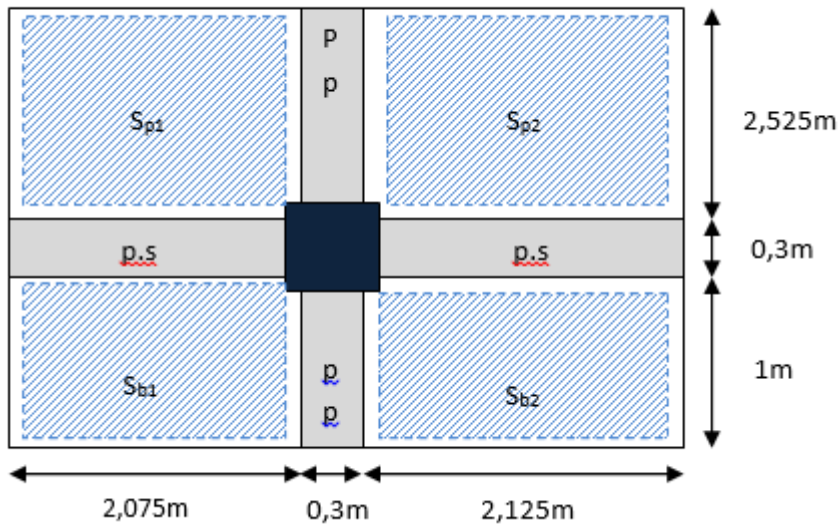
Les sections entourées par le poteau intermédiaire à l'étage
